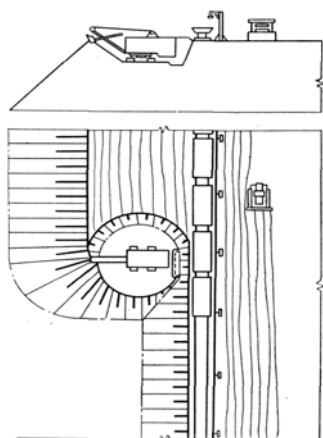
Планування поверхні слідом за переміщенням фронту відвальних робіт
